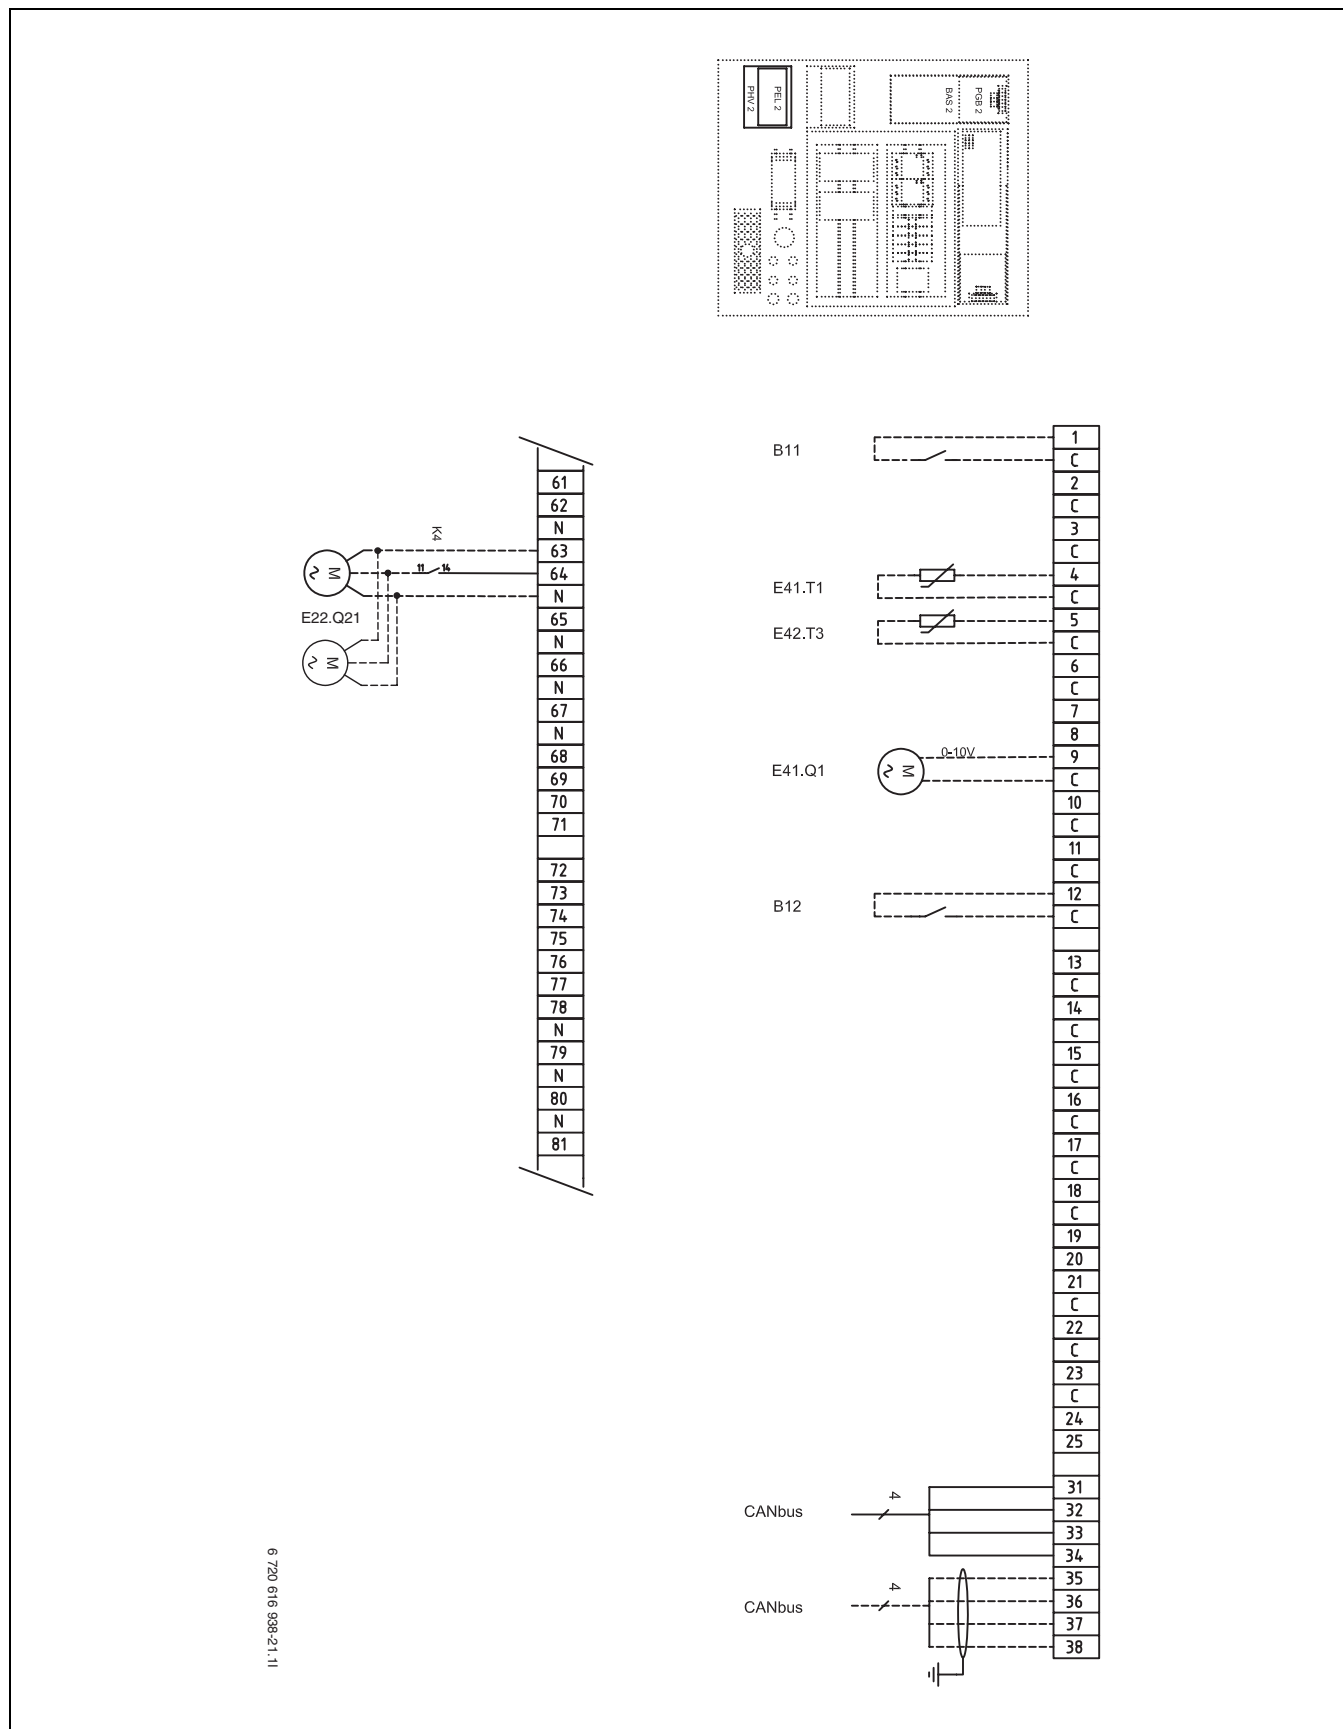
Externe Anschlüsse E22 (T 220-1 - T 600-1)
